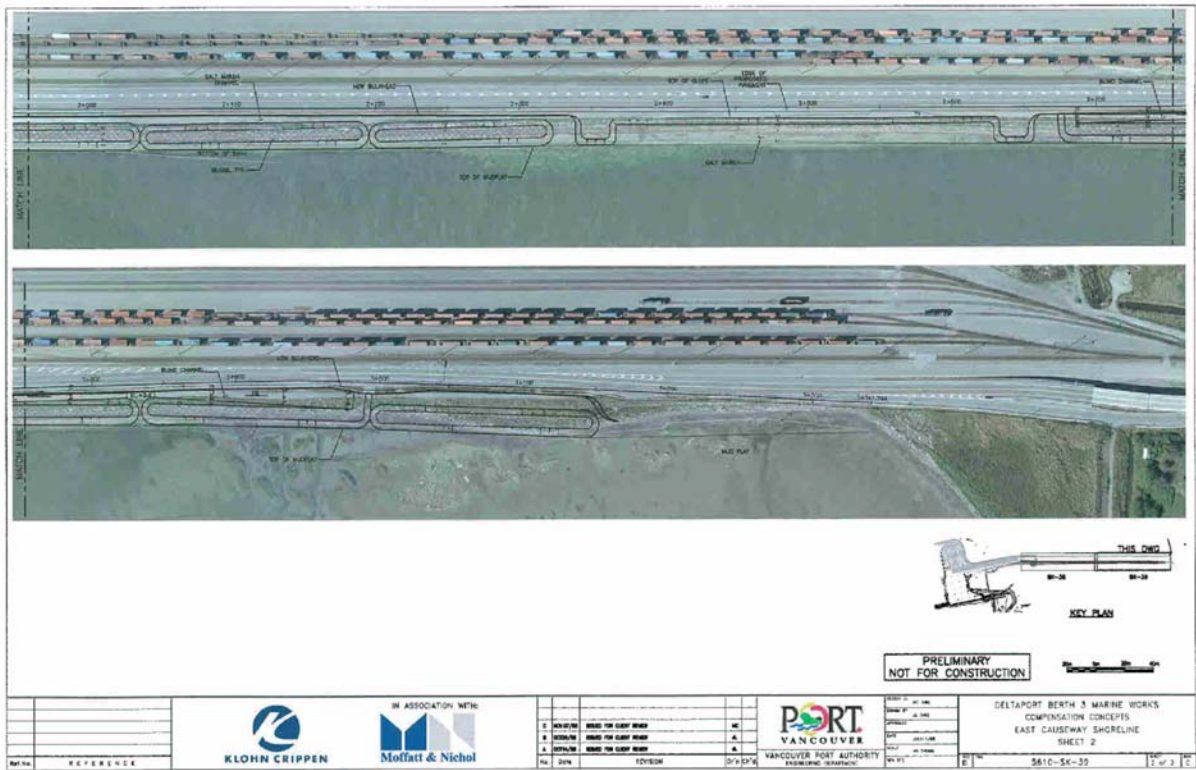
Chaussée Nord-Est – dessin no. SK-39
